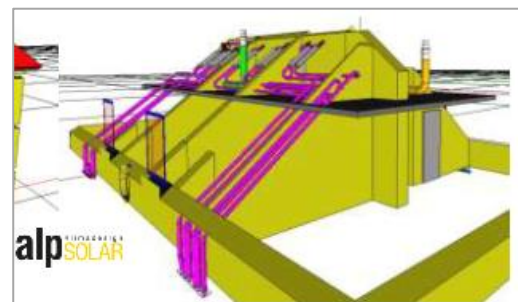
Gebäudezentrale Wohnraumlüftung mit fassadenintegrierter Luftverteilung bei der Sanierung eines 4-geschossigen Mehrfamilienhauses der NHT (Neuen Heimat Tirol) – Kostenreduktion durch gewerkeübergreifende Planung und den Verzicht auf Installationsmaßnahmen innerhalb der Wohneinheiten.
